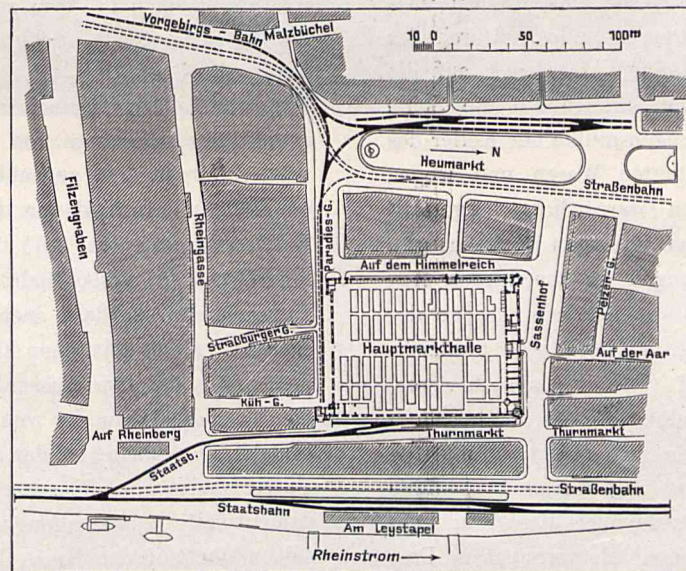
Lageplan nach Errichtung der Hauptmarkthalle.
